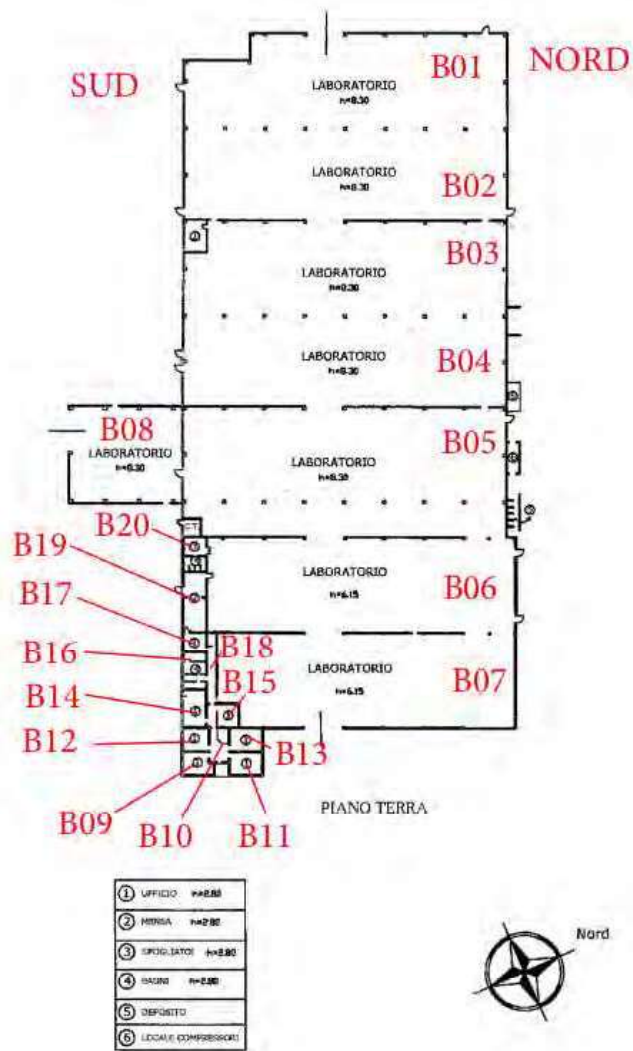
Ostiglia - Capannone B - Planimetria con indicazione locali
